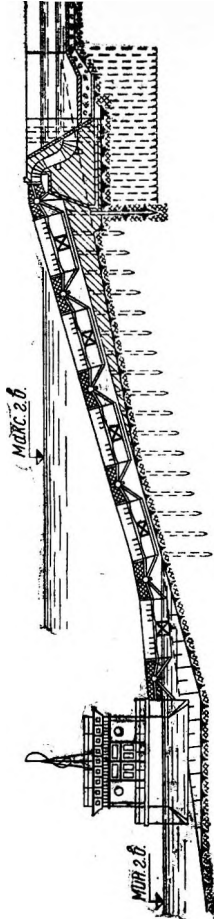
Плавающая насосная станция на железобетонном понтоне.
